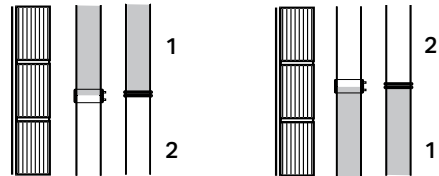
Переход с электромуфтой Geberit или стыковой сваркой
